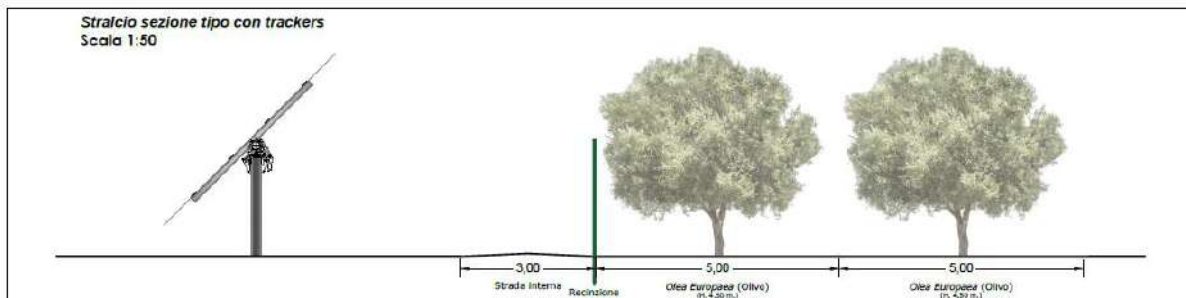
Stralcio sezioni tipo su fissi e su trackers fascia di mitigazione
